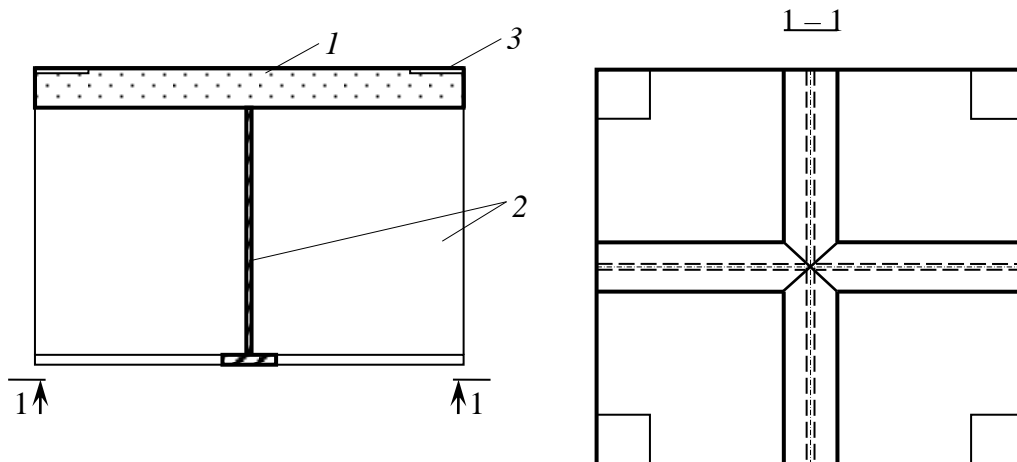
Сталезалізобетонний елемент збірної комплексної конструкції часторебристого перекриття
